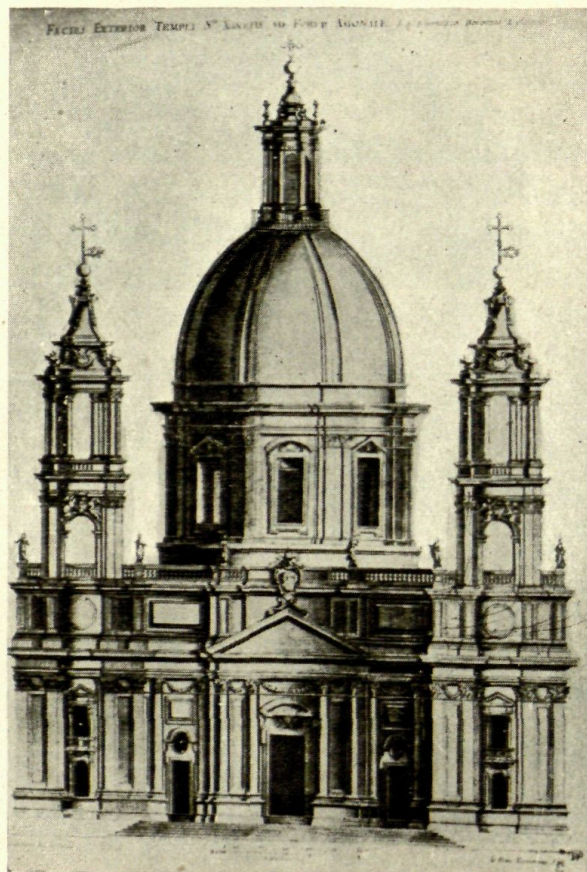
Fachada de Santa Inés, en Roma*,
